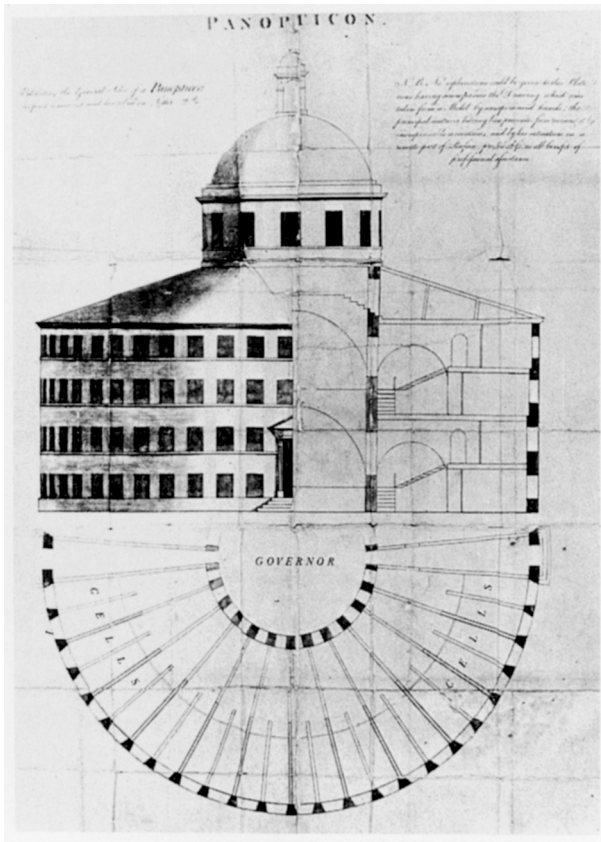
Jeremy Bentham, Entwurf für ein Panopticon, 1787, Aufriss, Schnitt und Grundriss.
